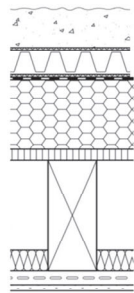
Einfluss der Schutzlage und der Drainage unterhalb des Gründach-Substrats. Weiterer Aufbau: Dachbahn, 140 mm Hartschaum-Dämmplatten, Holzwerkstoffplatte, 220 mm Balkenlage mit 40 mm Faserdämmstoff, Federschiene, 12,5 mm GKF
